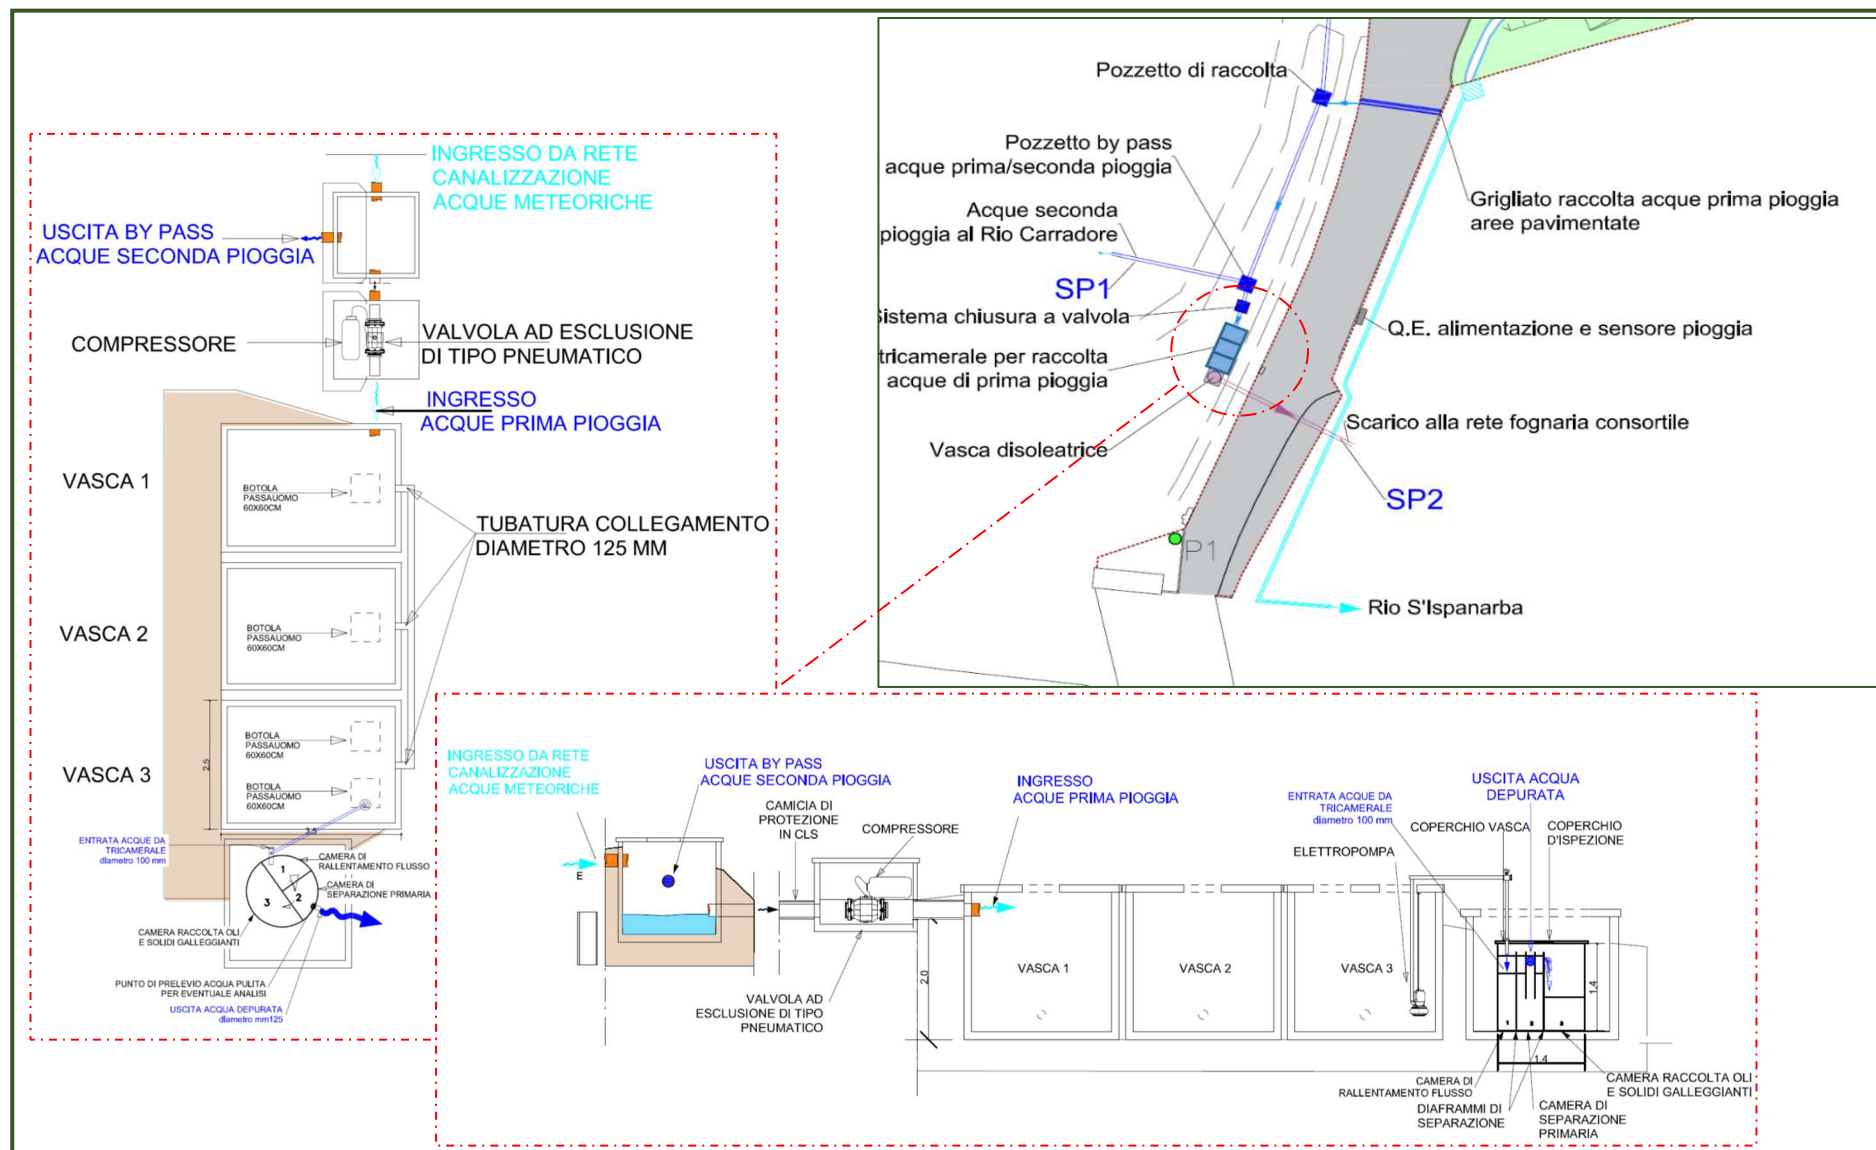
/VIII: Schema impianto di trattamento acque di prima pioggia installato
